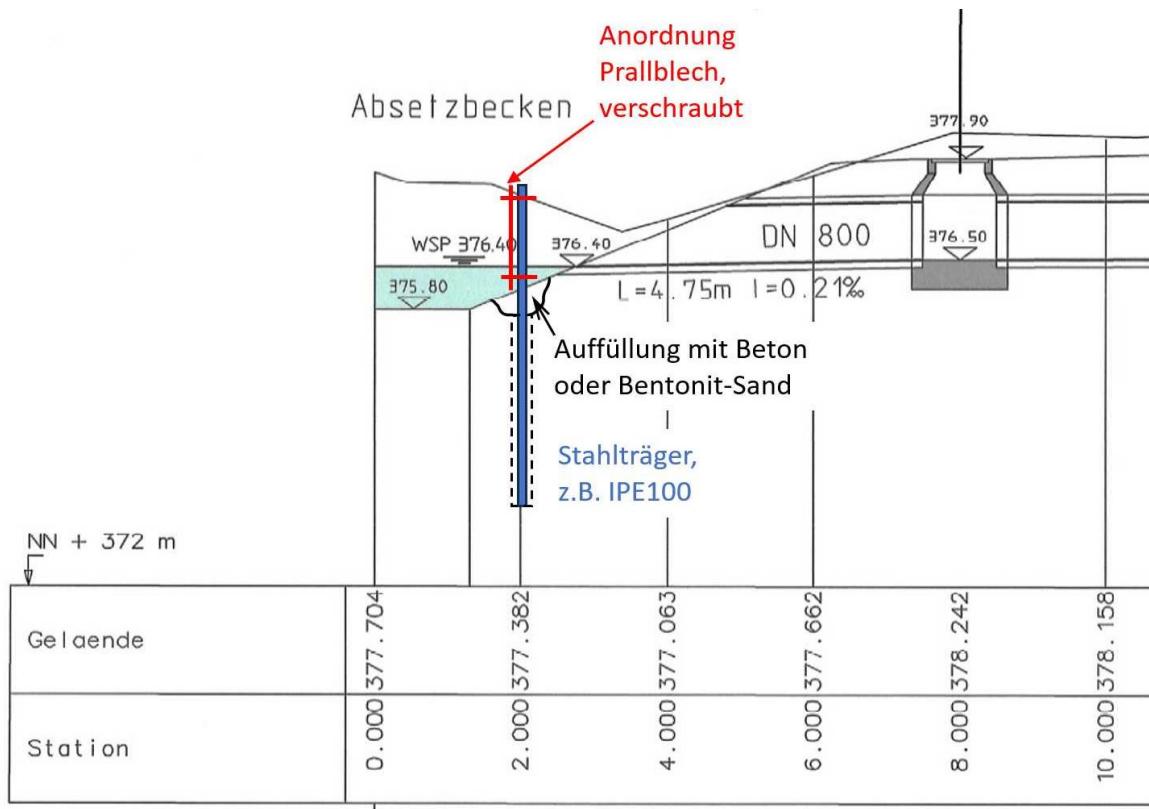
Skizze Schnitt Prallblech vor Zulaufleitung, Befestigungsvariante mit Einbindung in den Untergrund
